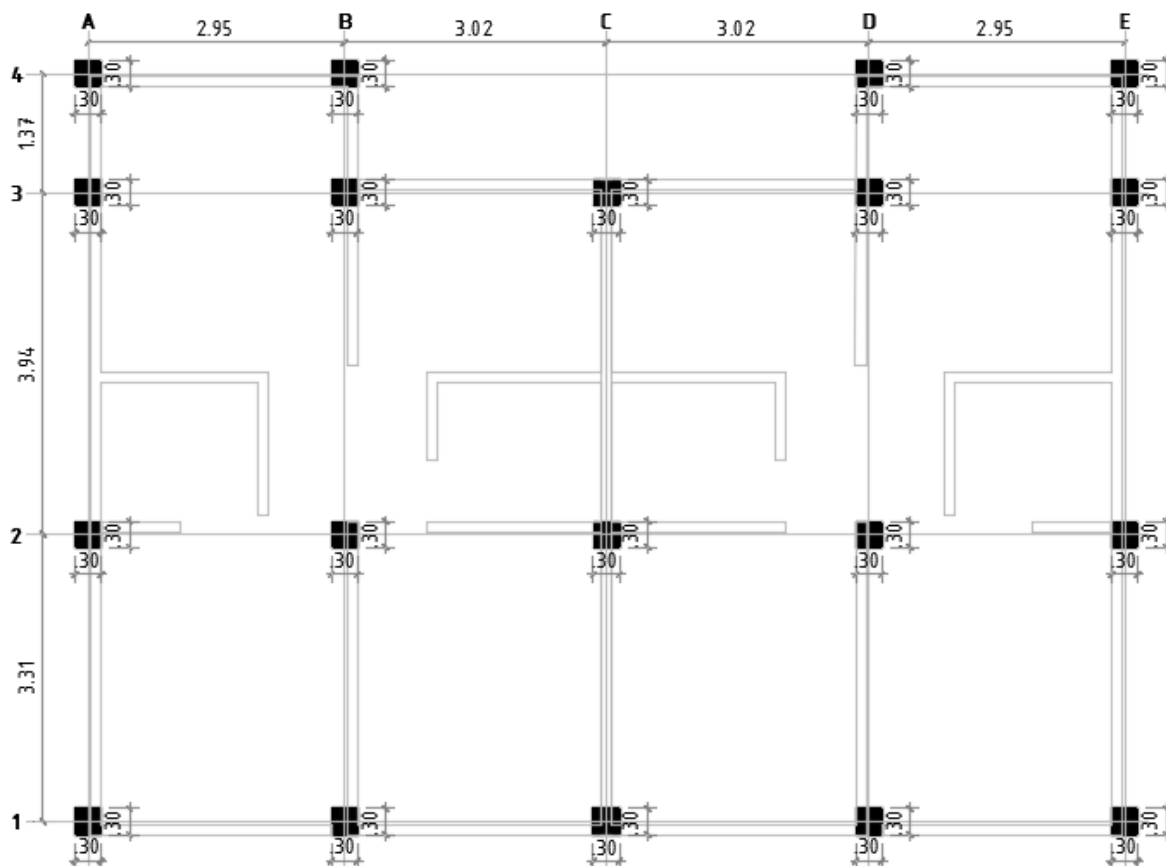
Replanteo de pórticos de viviendas de dos pisos (planta nivel 2)
